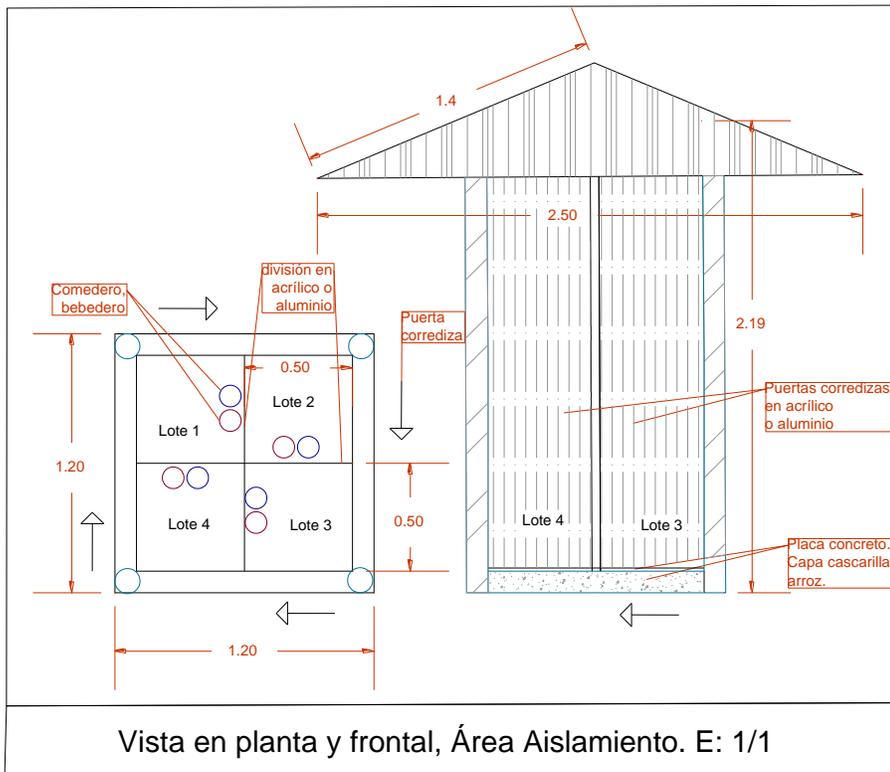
Plano vista en planta y frontal de área de aislamiento
